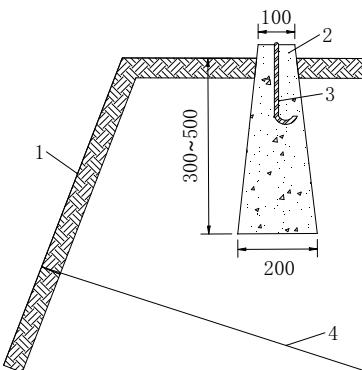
基坑边坡顶部水平位移监测点（单位：mm）
